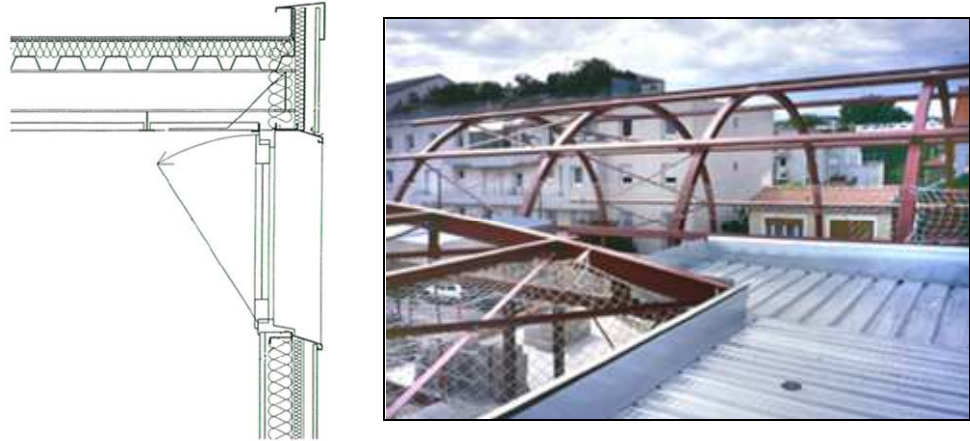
Esquina de fachada y de tejado – Vista de cubierta colocada
